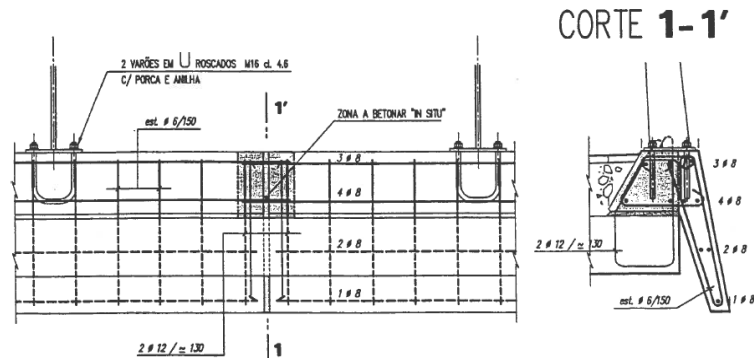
Disposição de viga de bordadura. Reis (2002)
